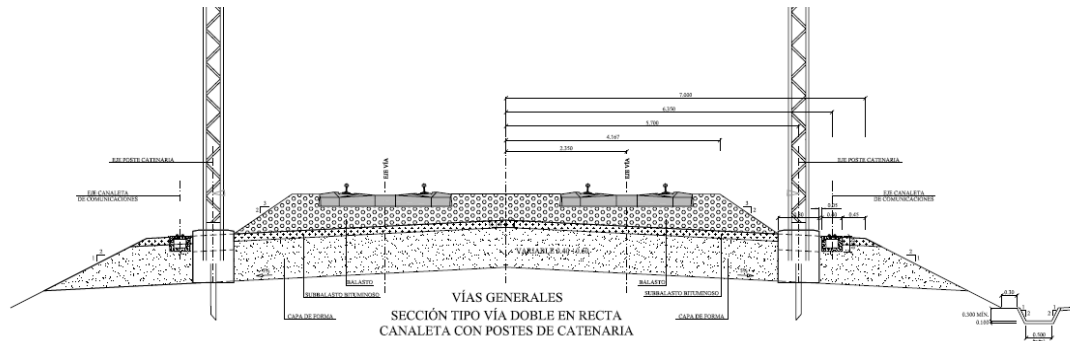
Sección tipo de vía (Fuente:ADIF)
